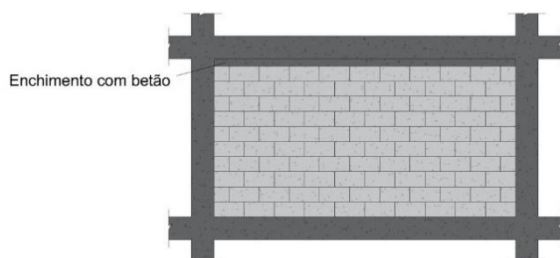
Enchimento de espaço vazio entre parede de alvenaria e pórtico com argamassa.
